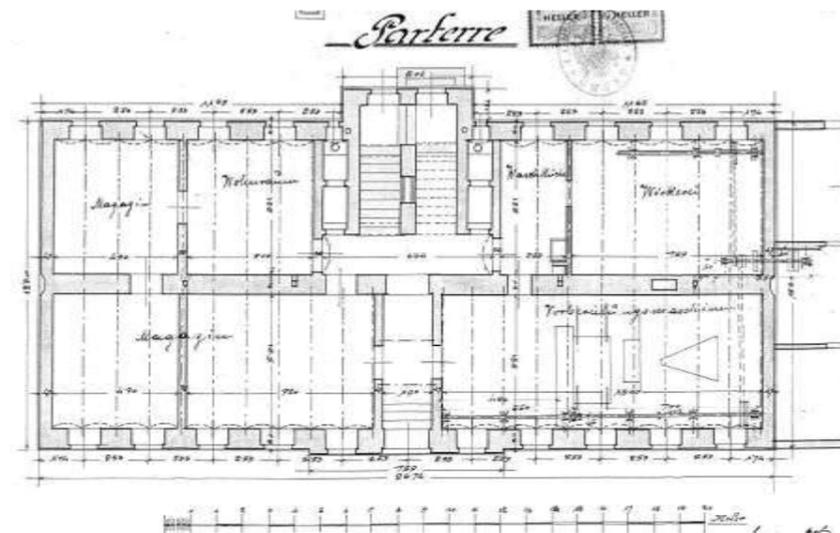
Wohnhaus (Erdgeschoss) – Einreichplan 1912
